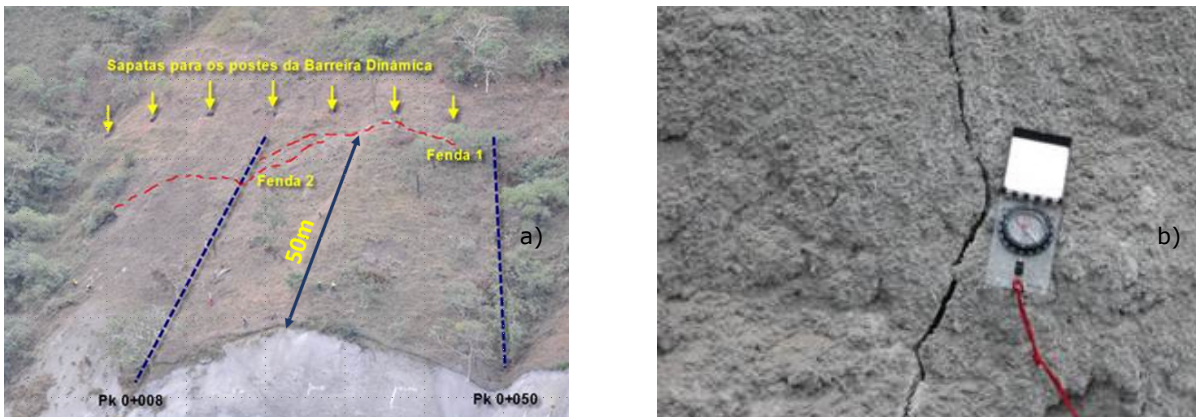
a) Escorregamento de grande porte ocorrido em Junho de 2015; b) Fissuração do betão projectado, abertura de 4 mm
